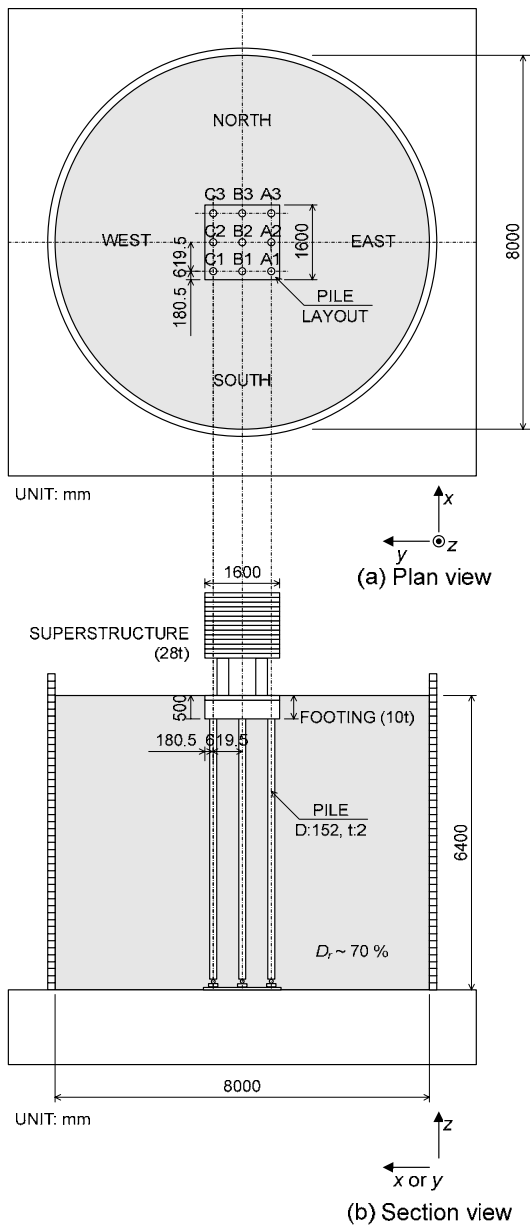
試験体の概略(タイプIII-1の杭基礎構造物) : (a) 平面図, (b)断面図
